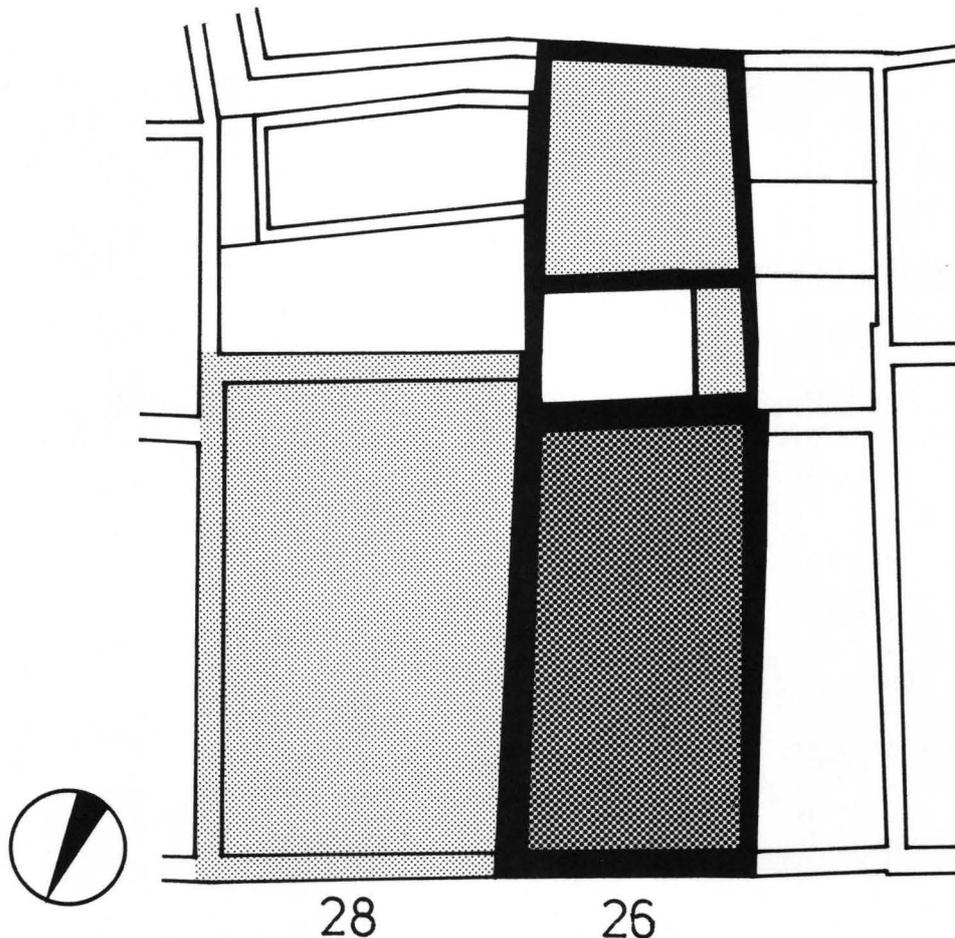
Grundriss vom Erdgeschoss von Haus Webergasse 26 (nach Falknerplan, 1875). – Zeichnung: St. Tramèr. – Massstab 1:200.
